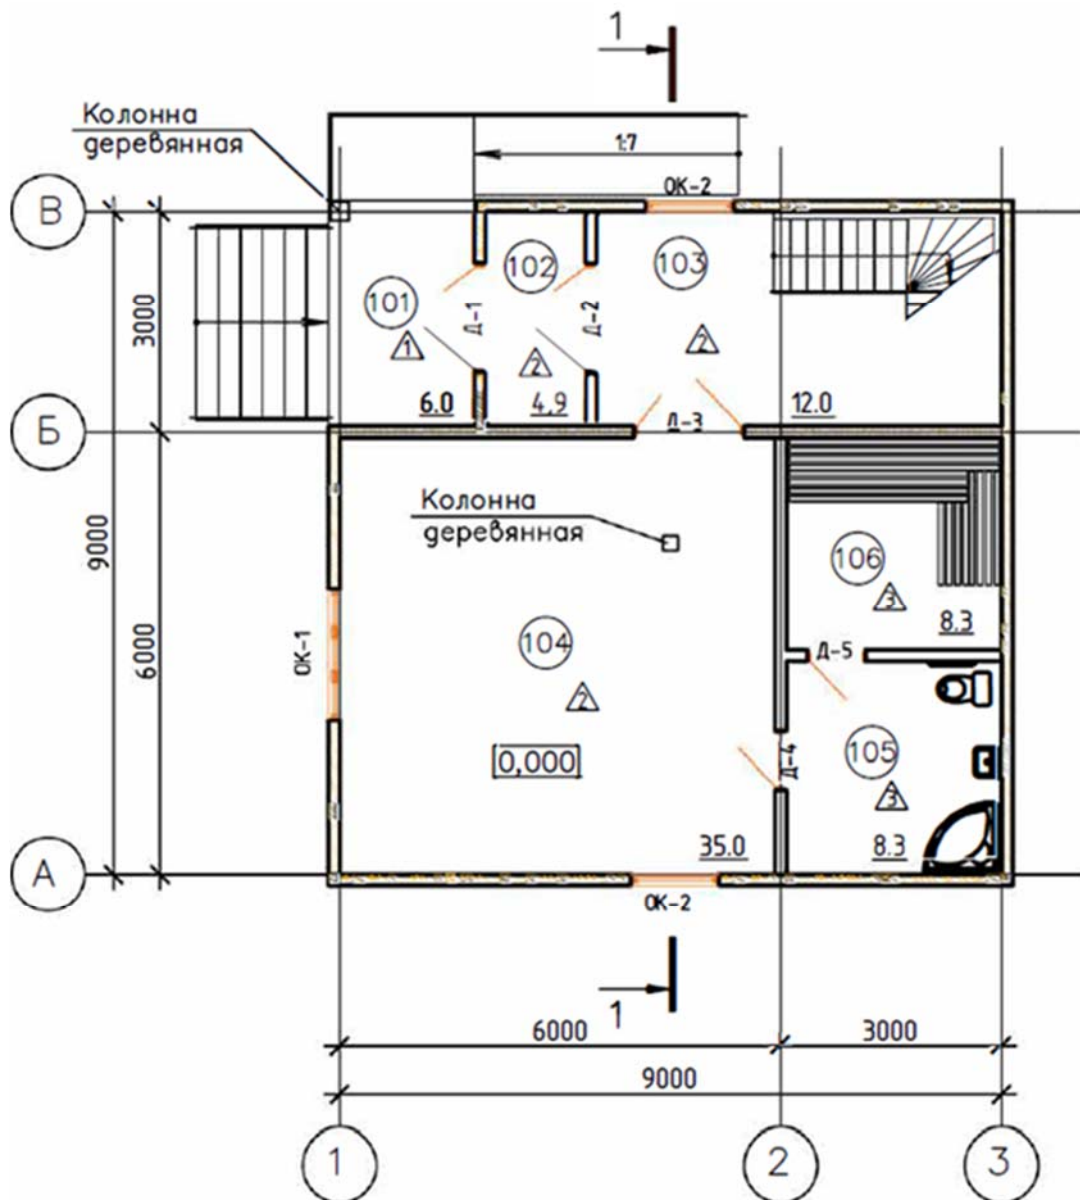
План 1-го этажа из раздела АР выполненного ООО «_____». Участки стен с выпусками бревен не показаны (см. рис 2).
